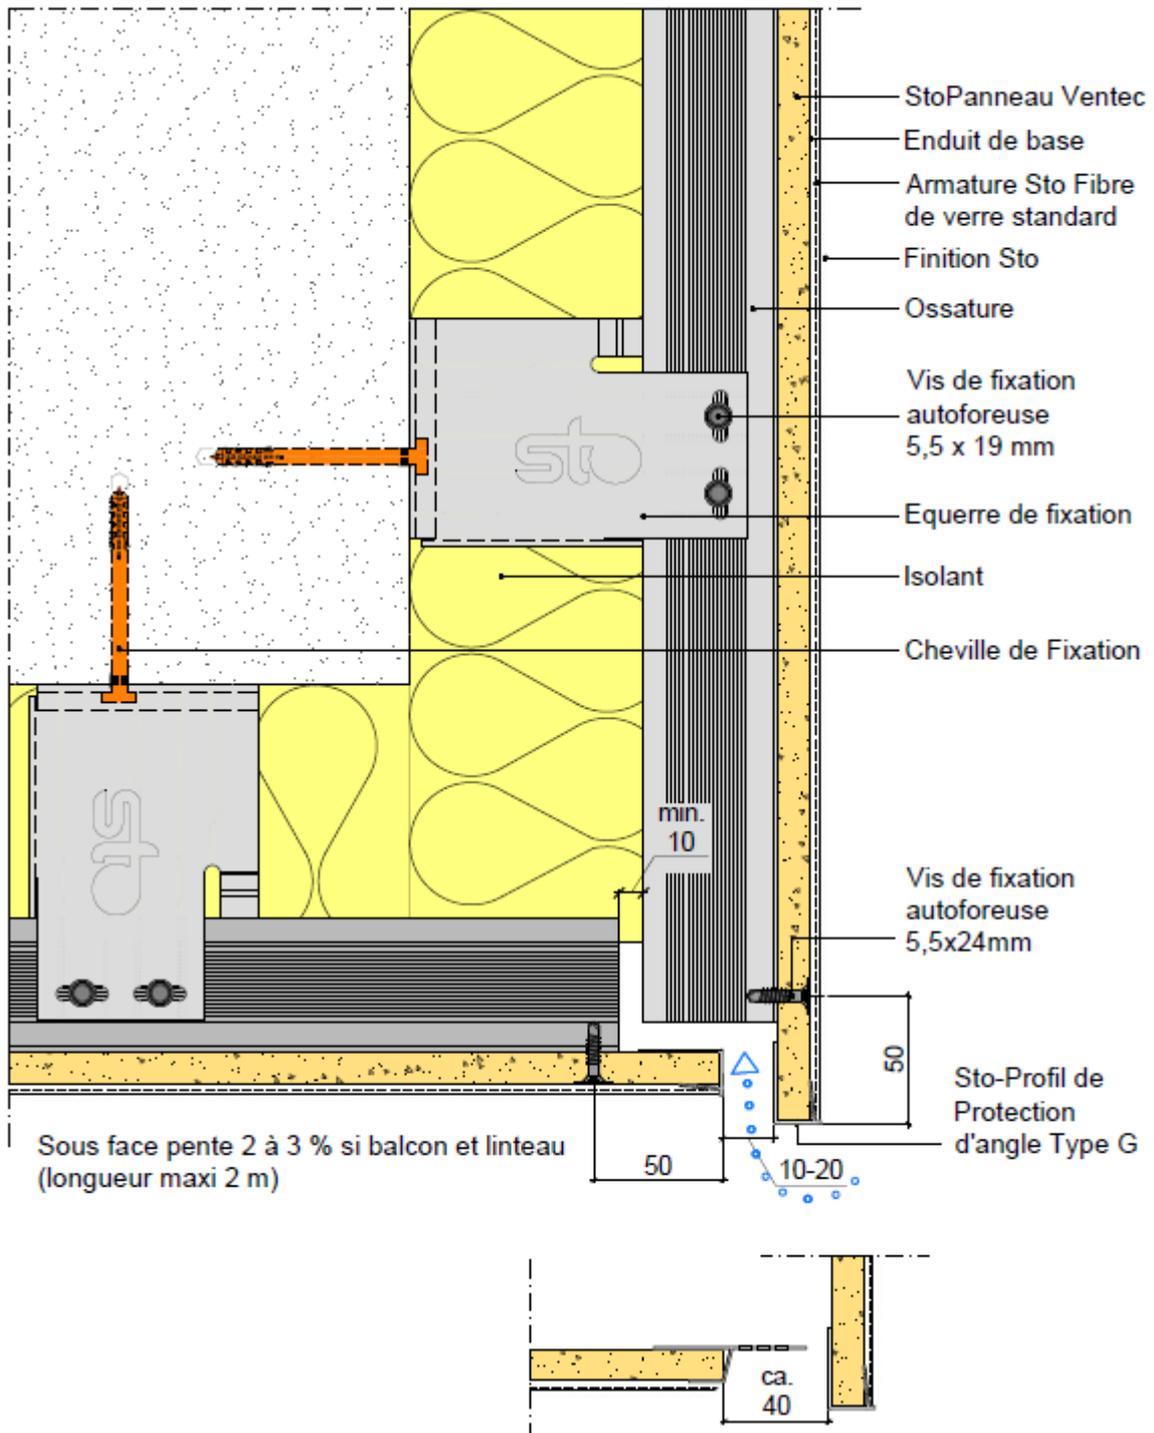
Coupe verticale - Pose en sous-face - Interface entre la sous-face et le bardage en retrait de la façade - Ossatures aluminium sur support béton
